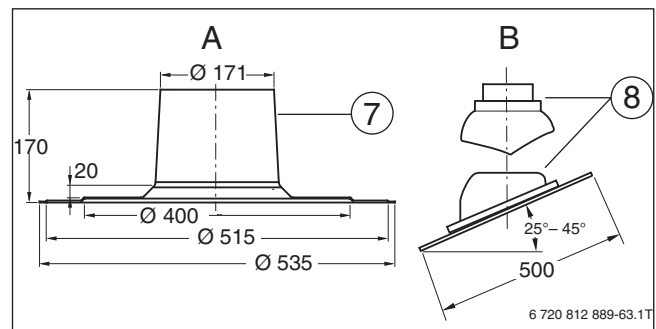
Universaldachpfannen und Flachdach-Klebeflansch als Zusatzausstattung für den Grundbausatz DO (unbedingt mitbestellen); (Maße in mm)
